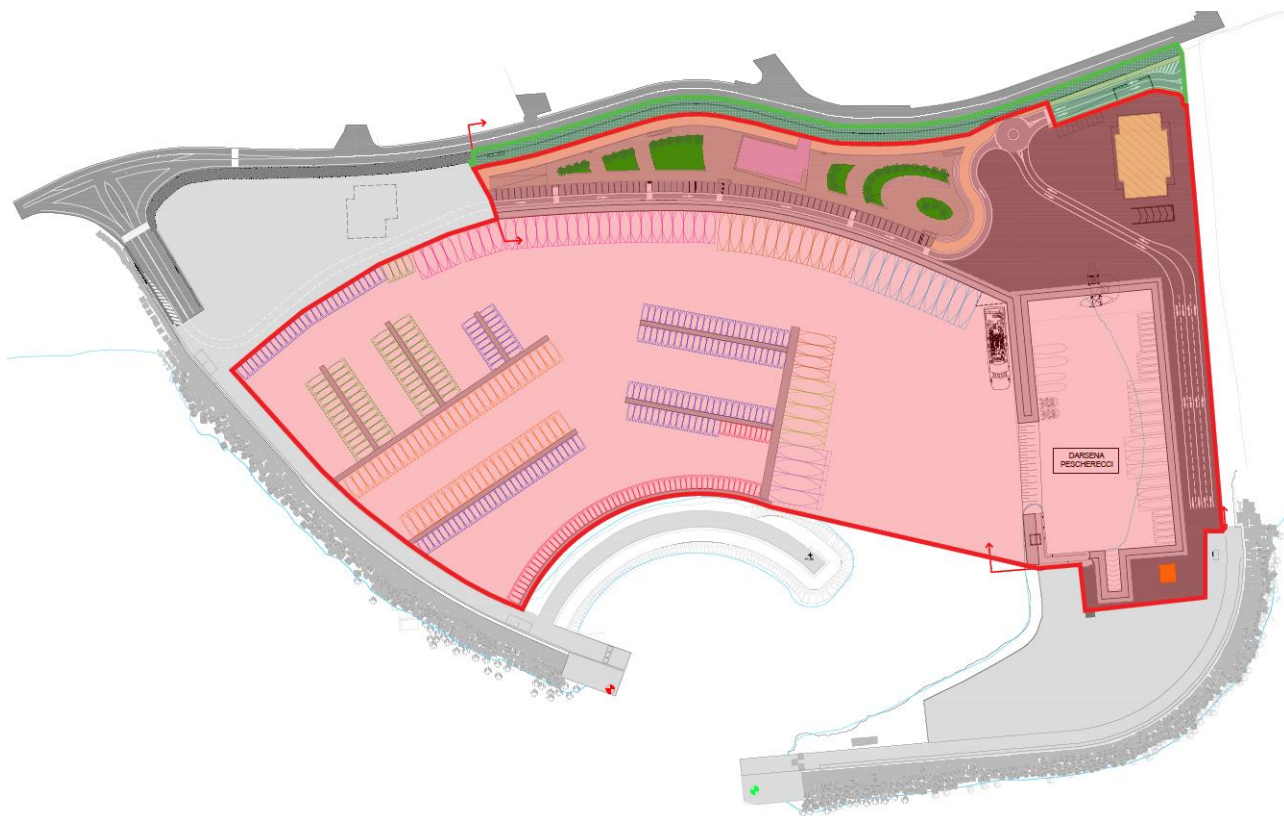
Planimetria di progetto con indicazione delle macroaree in progetto
